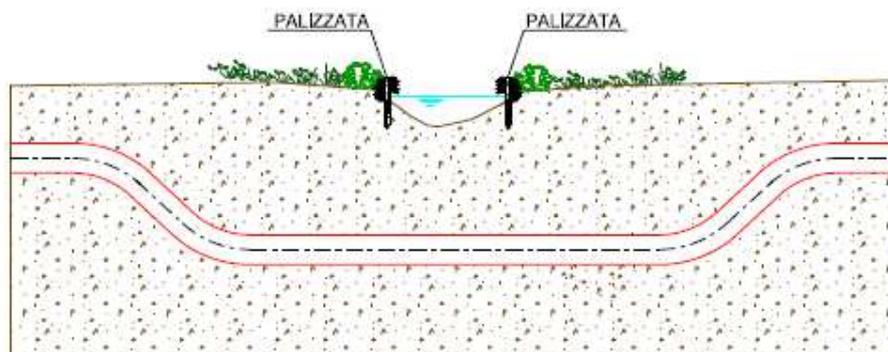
Attraversamento torrente Saccione - Sezione schematica di progetto
